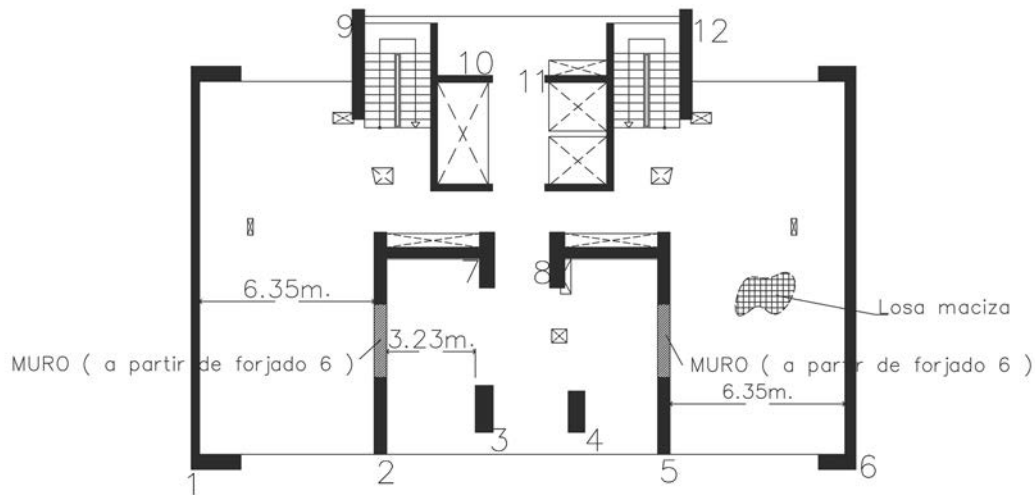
Distribución de elementos verticales en planta tipo en torre izquierda
